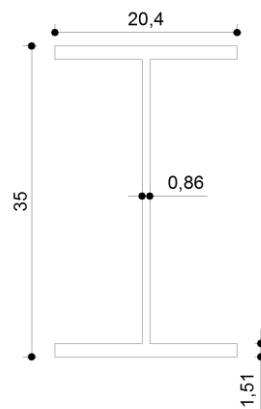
Dimensiones del perfil W14x48, dimensiones en cm.
